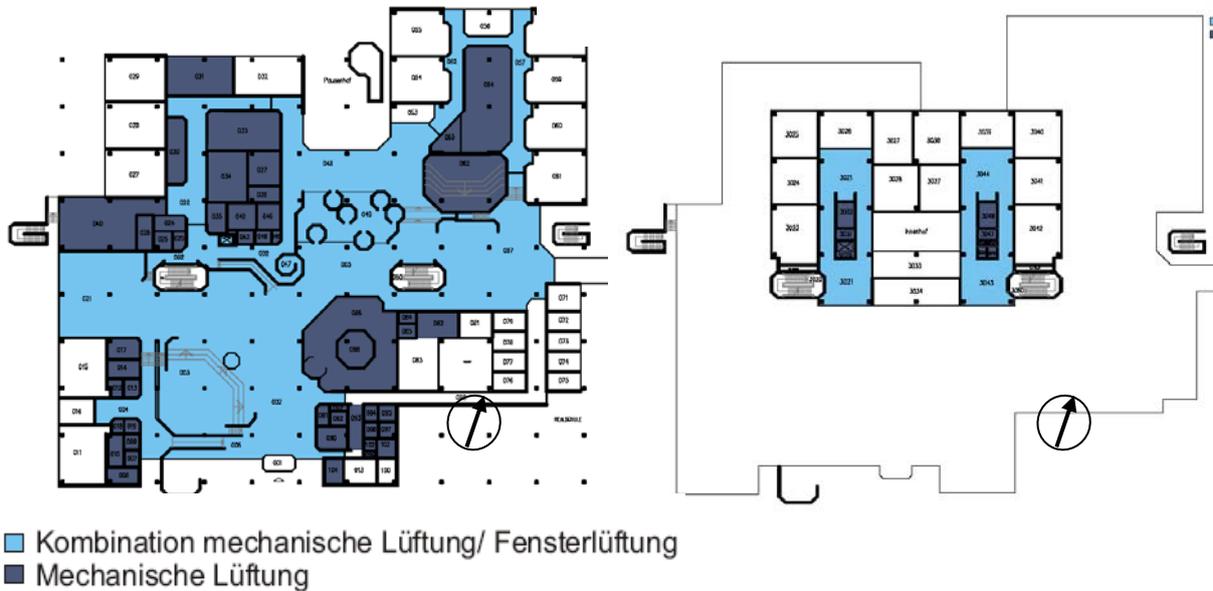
Grundriss EG und 1.OG (wie 2.OG)
